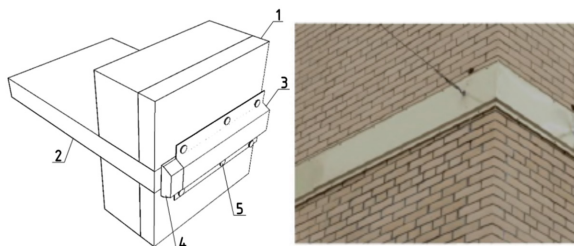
Устройство для утепления наружной стены здания. Вариант 1:
